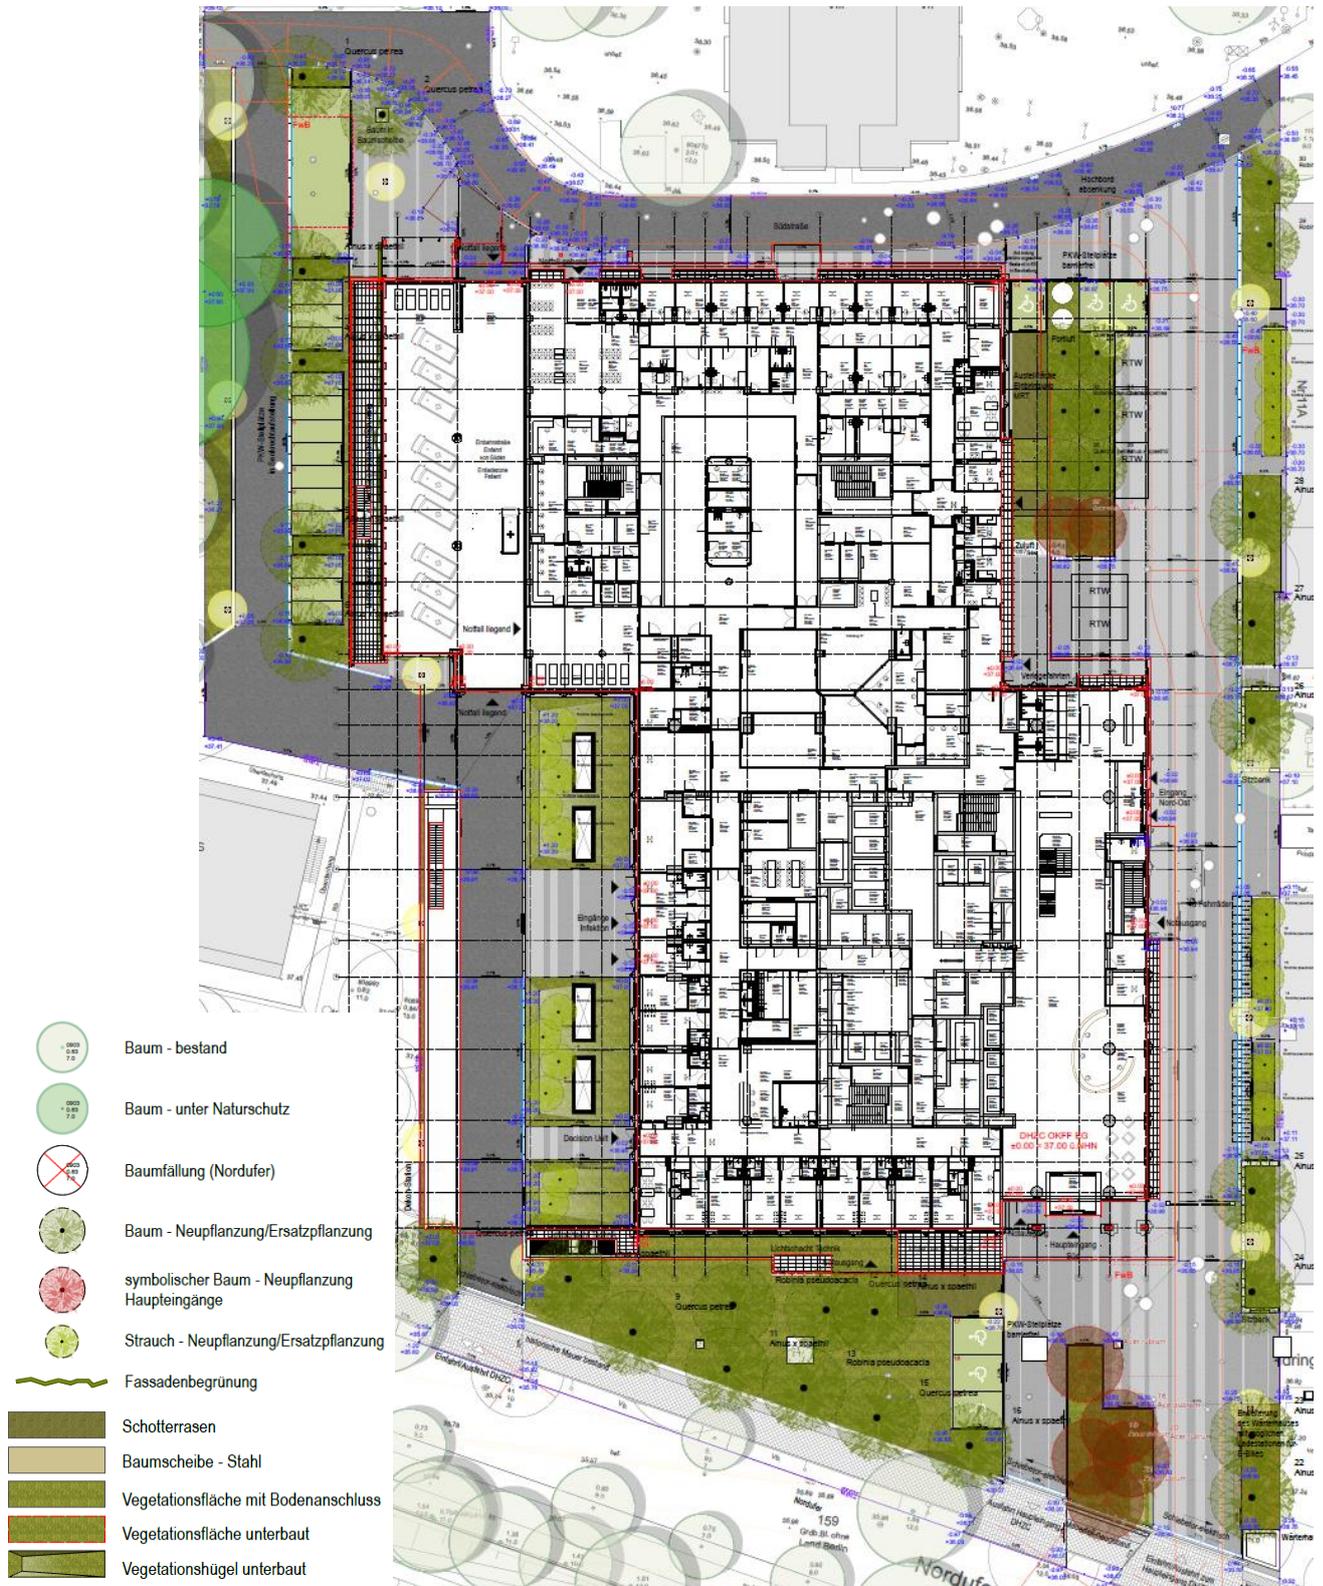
Außenanlageplan Neubau DHZC, zugeschnitten (TOPOTEK 1, STAND 17.02.2023)
